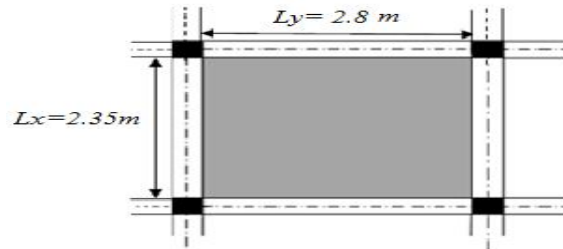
Présentation de la dalle pleine d'ascenseur.
